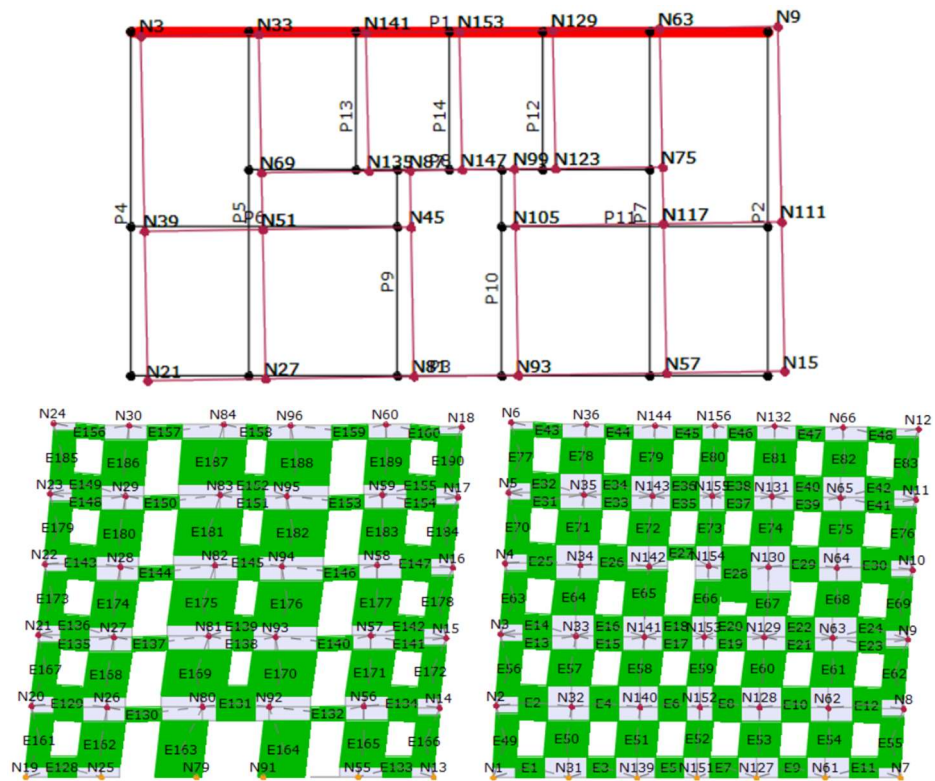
Primeiro modo de vibração: Planta e alçados das paredes WX5 e WX1
